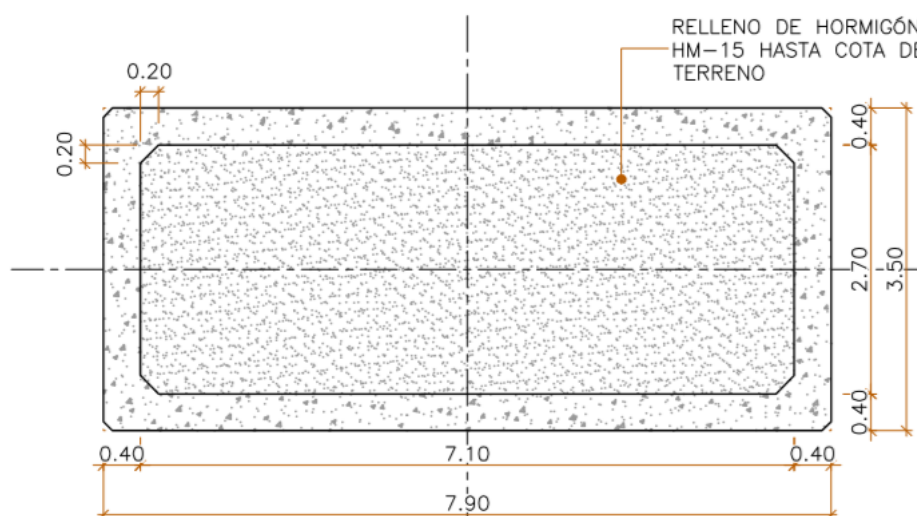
Sección transversal de las pilas tipo 1. Fuente: Proyecto de construcción de plataforma del corredor mediterráneo de Alta Velocidad Murcia – Almería.
